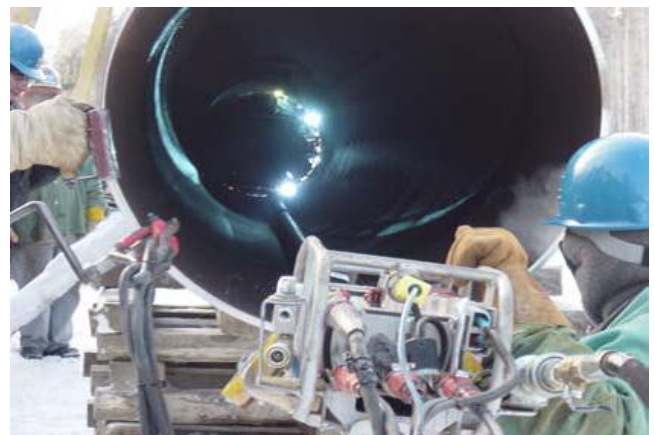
内面自動溶接施工(陸上パイプライン)
